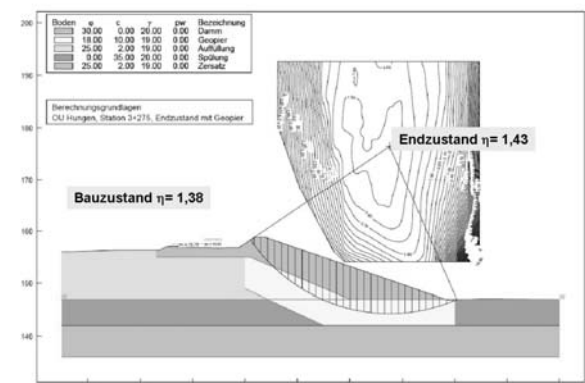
Dammsicherheitsberechnungen mit Baugrundverbesserung
